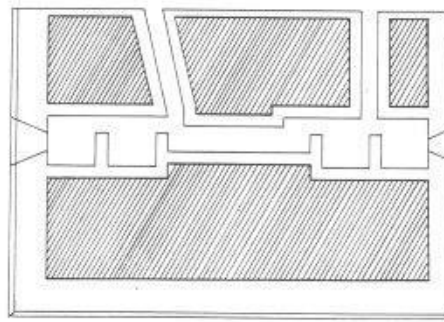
Planta do fortim de São Caetano copiada da planta de 1896
